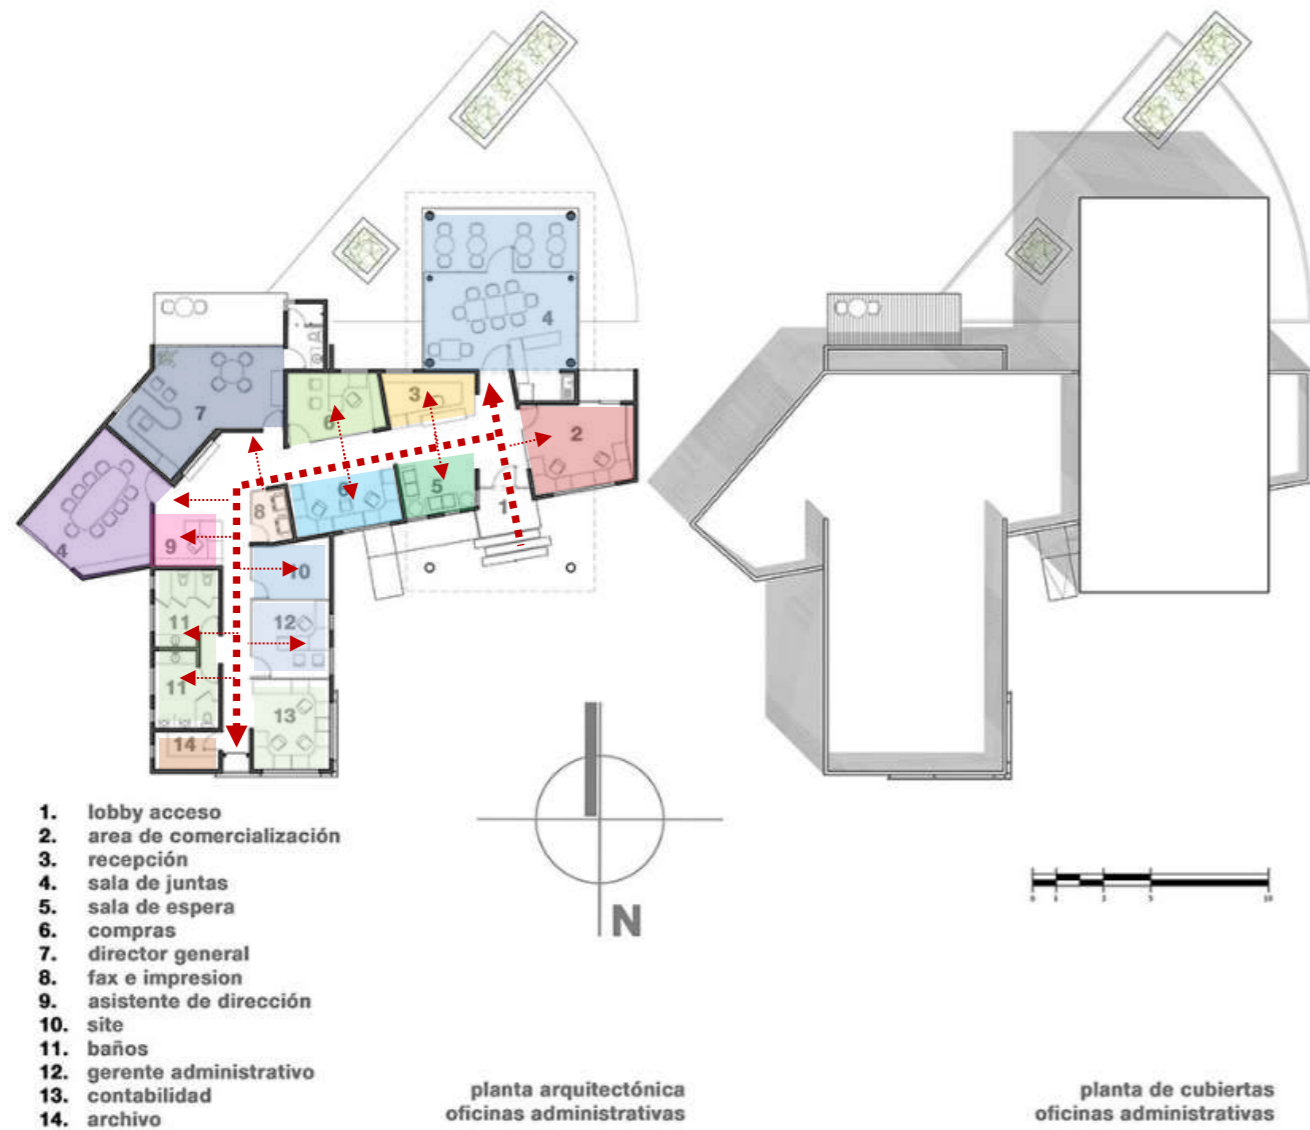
Planta arquitectónica Planta liofilizadora de café
